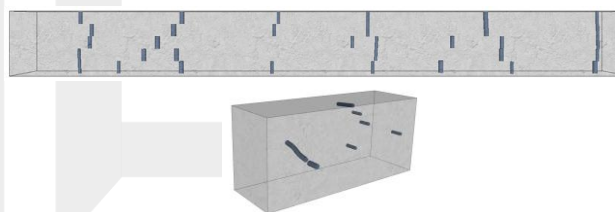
Vista 3D de acero de Viga (FS77, FS78)
